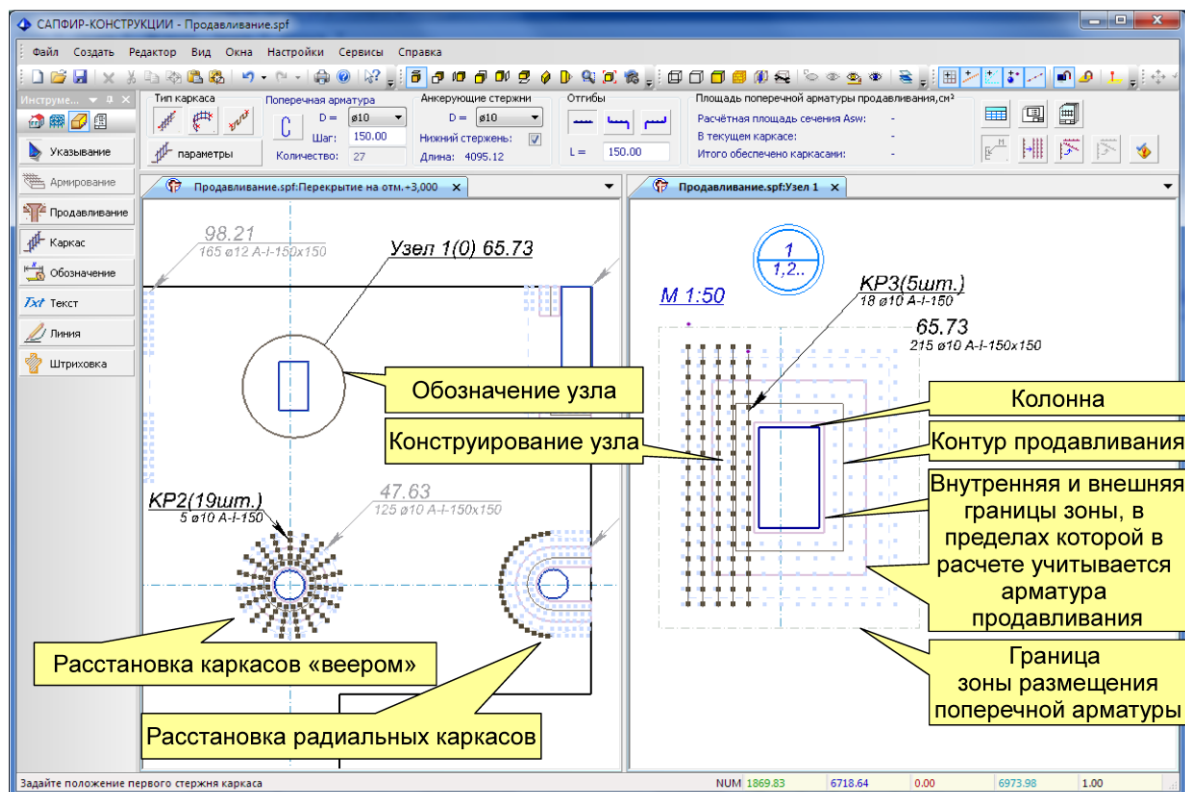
Конструирование и размещение каркасов на схеме и в отдельном узле армирования
